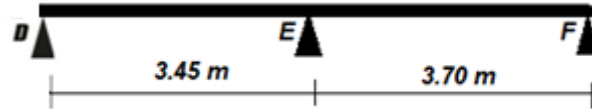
Schéma du 3^{ème} type de poutrelle.
